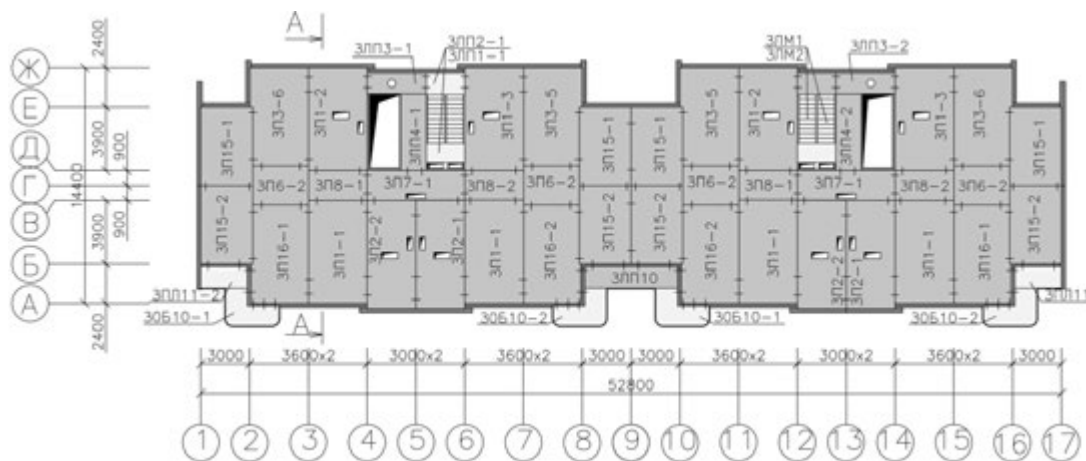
Спирання плит перекриттів на внутрішні поздовжні та поперечні панелі стін по контуру
